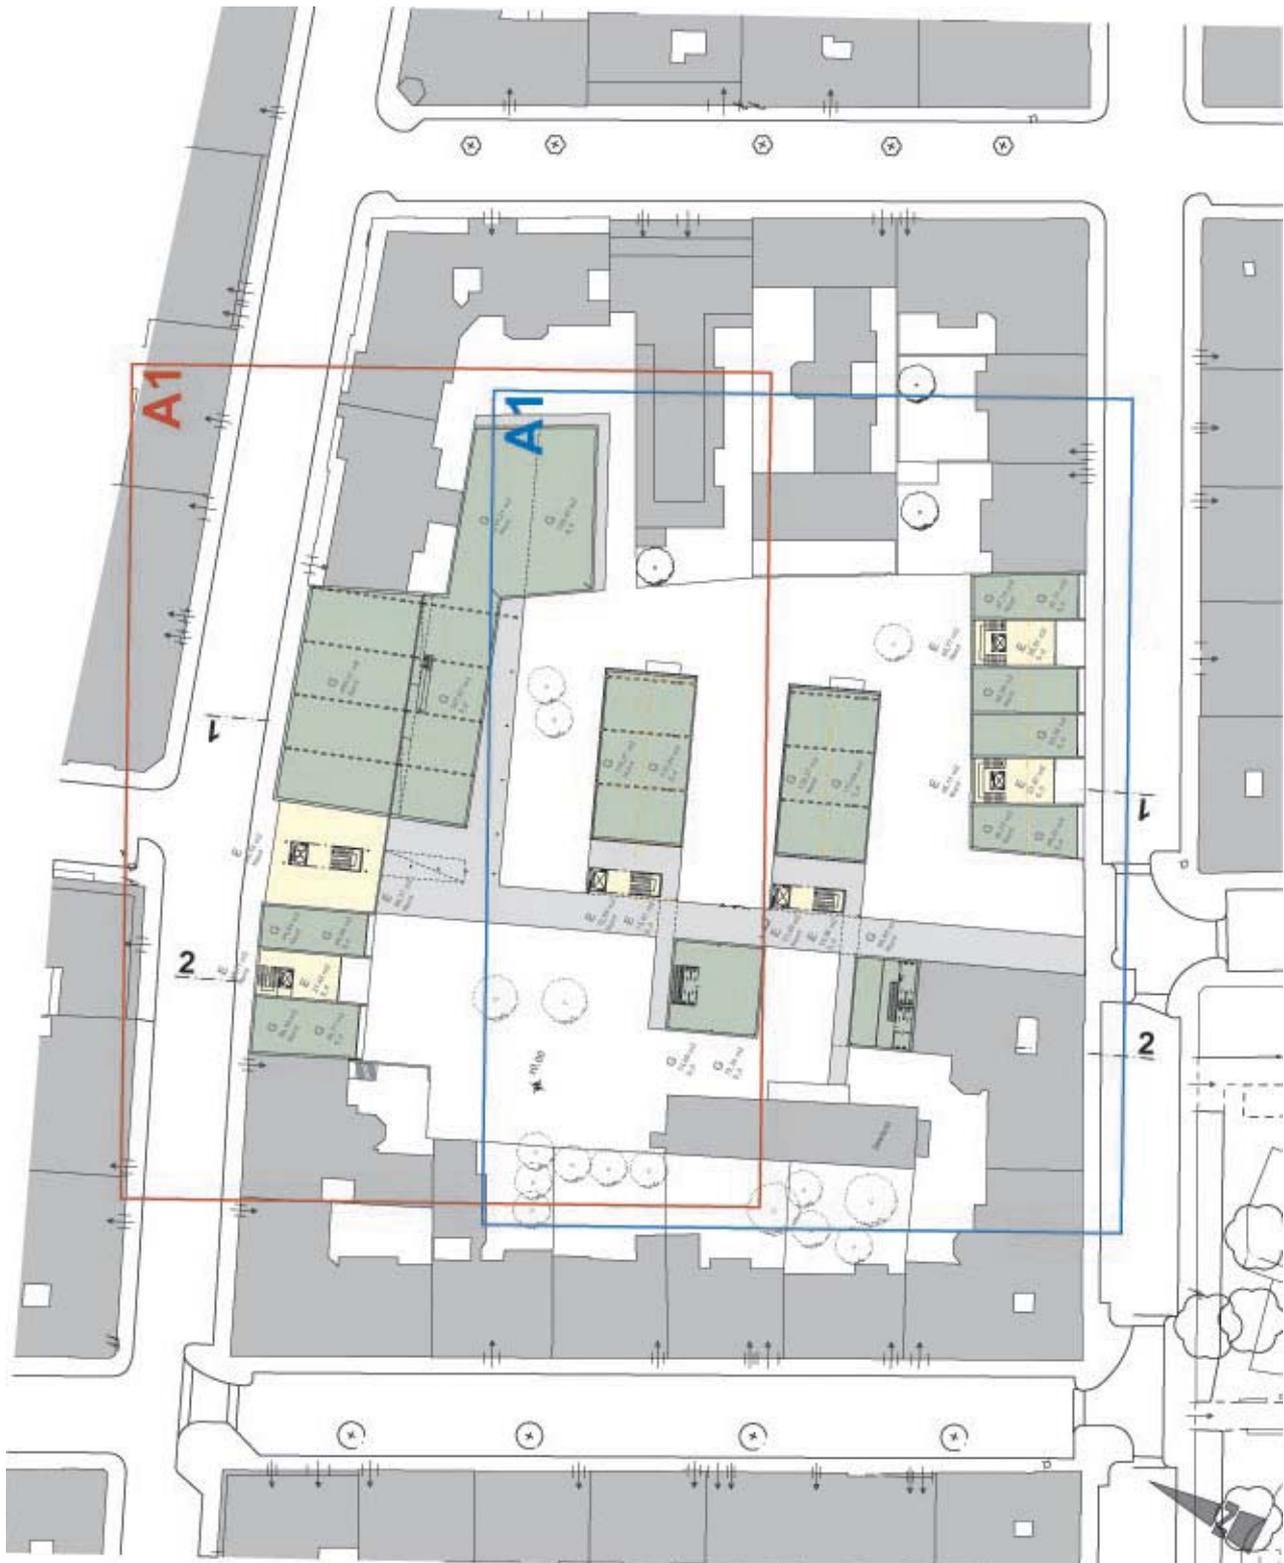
Margaretenstraße, Lageplan M = 1:1000
